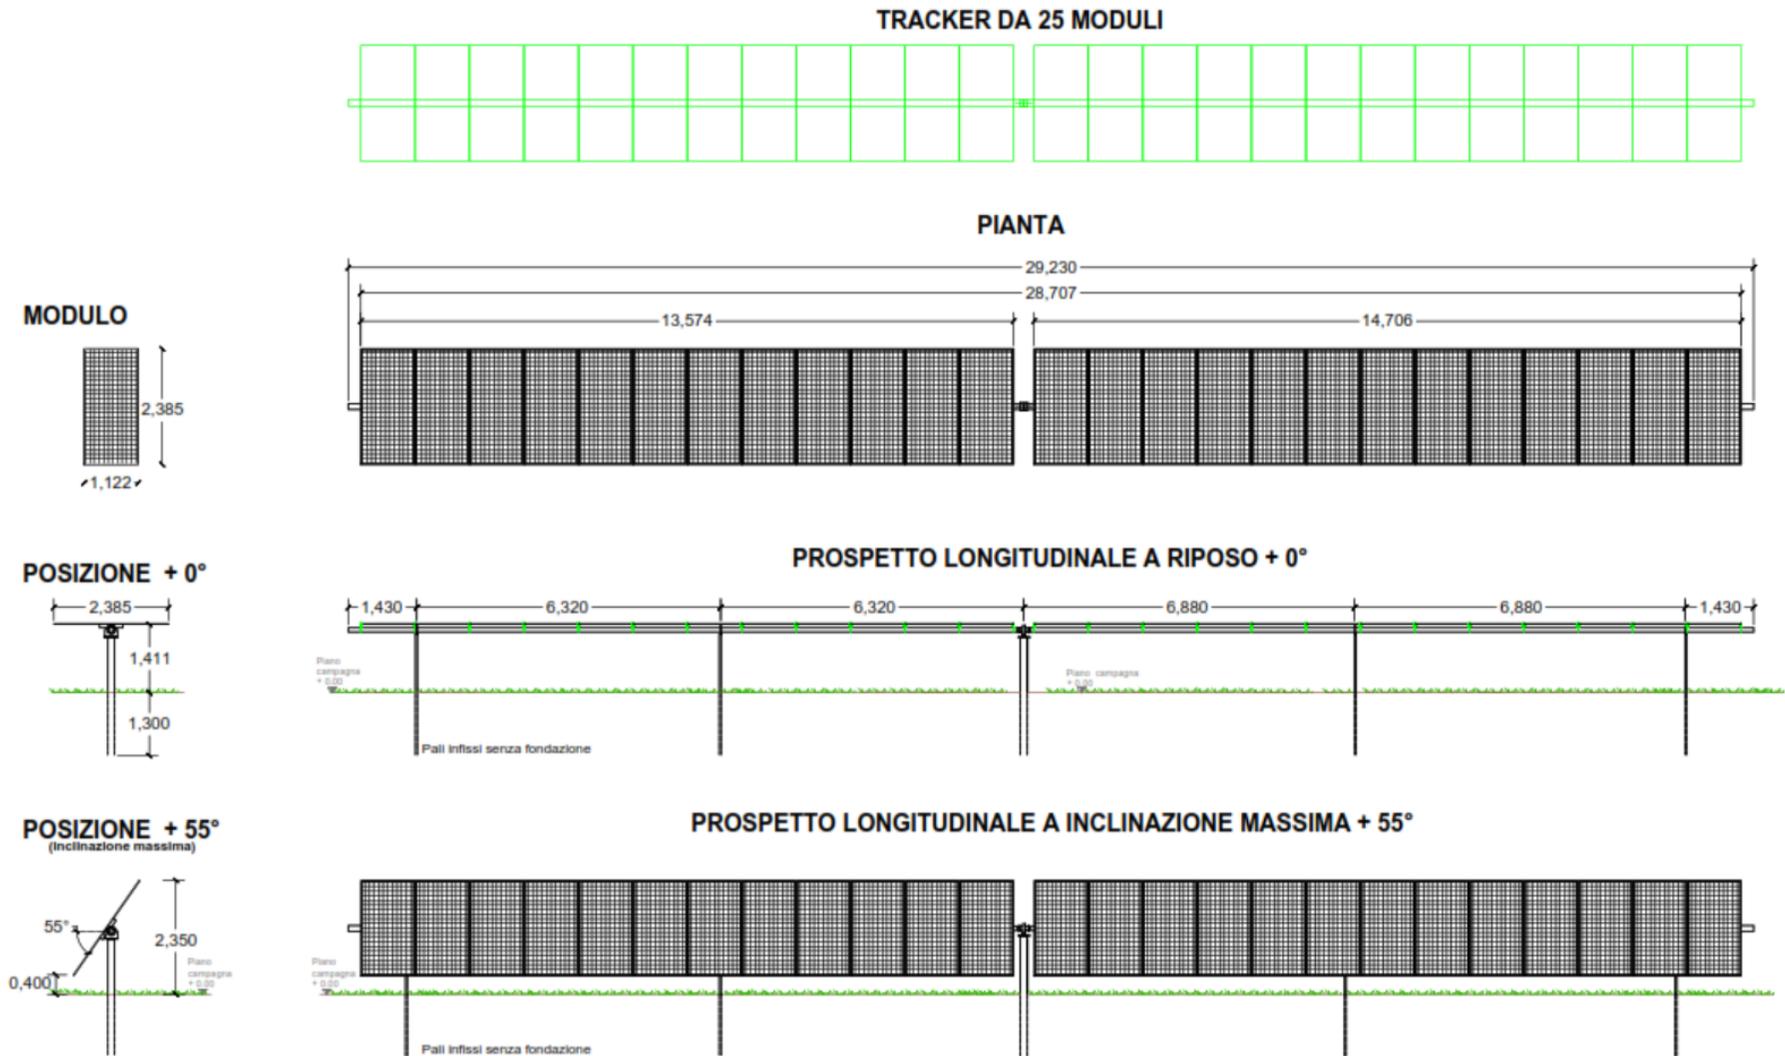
Pianta e prospetto dei moduli fotovoltaici previsti per l’impianto in progetto (casistica con tracker da 25 moduli).
